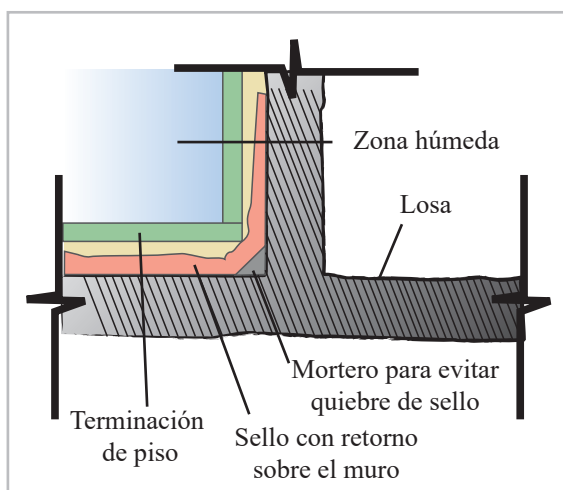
Elementos de protección, encuentro entre muro y losa
